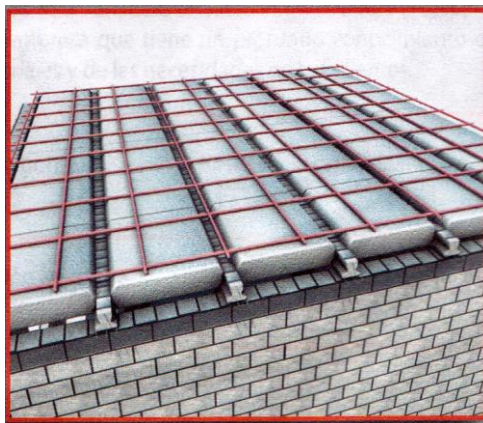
Armadura de distribución sobre la losa alivianada.
